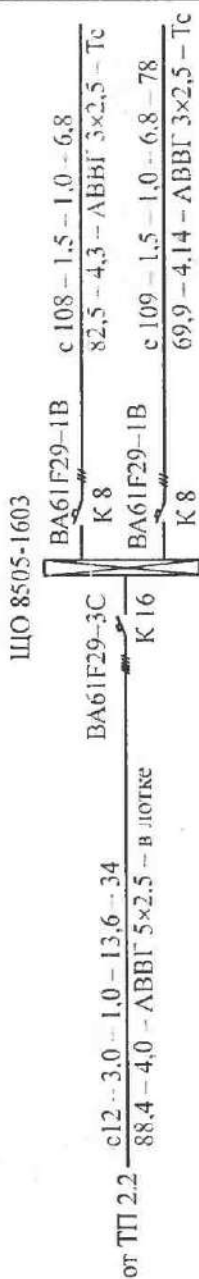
Фрагмент плана осветительной сети механического цеха
